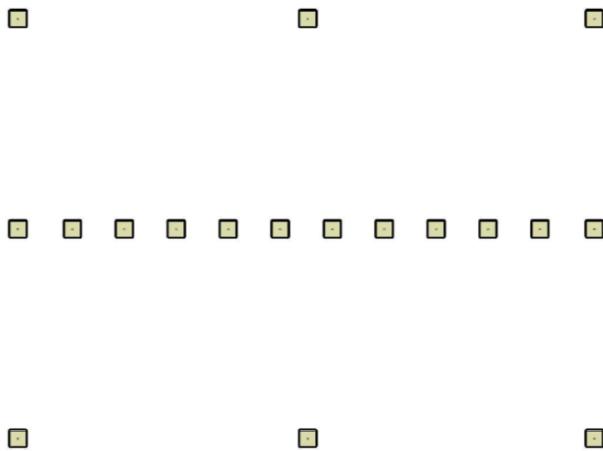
Planta da distribuição das sapatas para o anteprojecto
